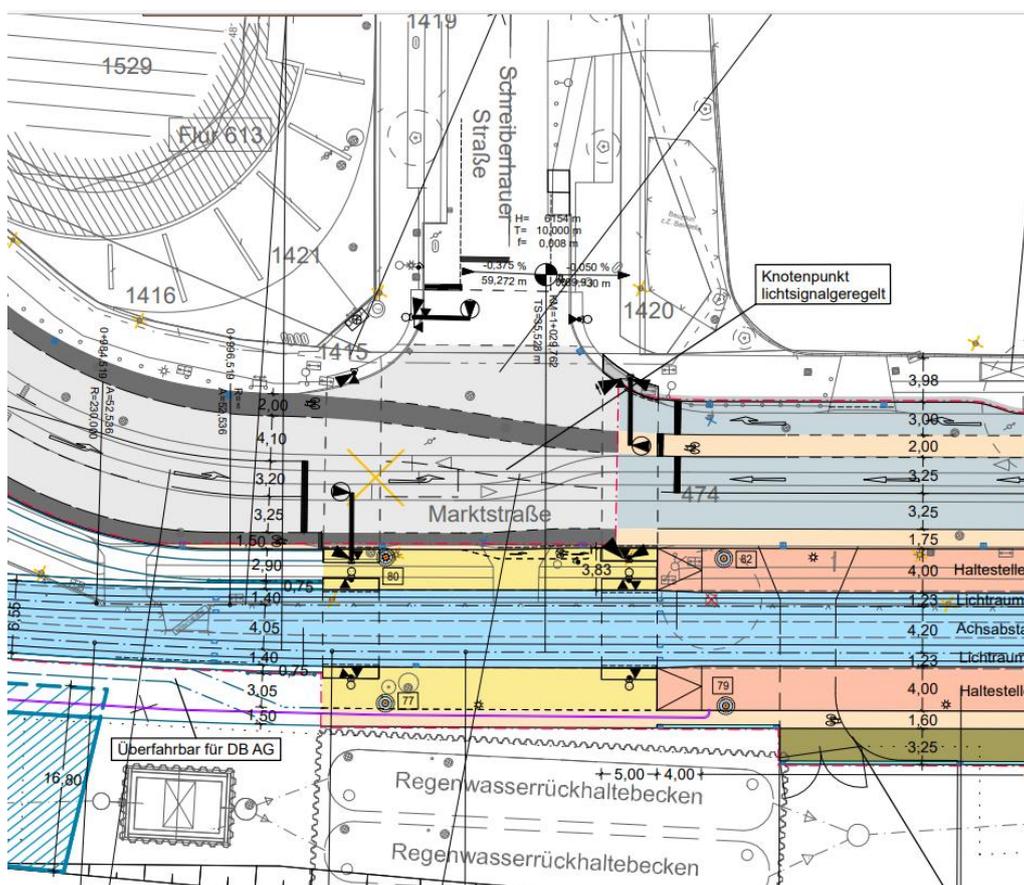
Ausschnitt aus dem Lageplan zur Planung der Straßenbahn-Neubaustrecke Ostkreuz
